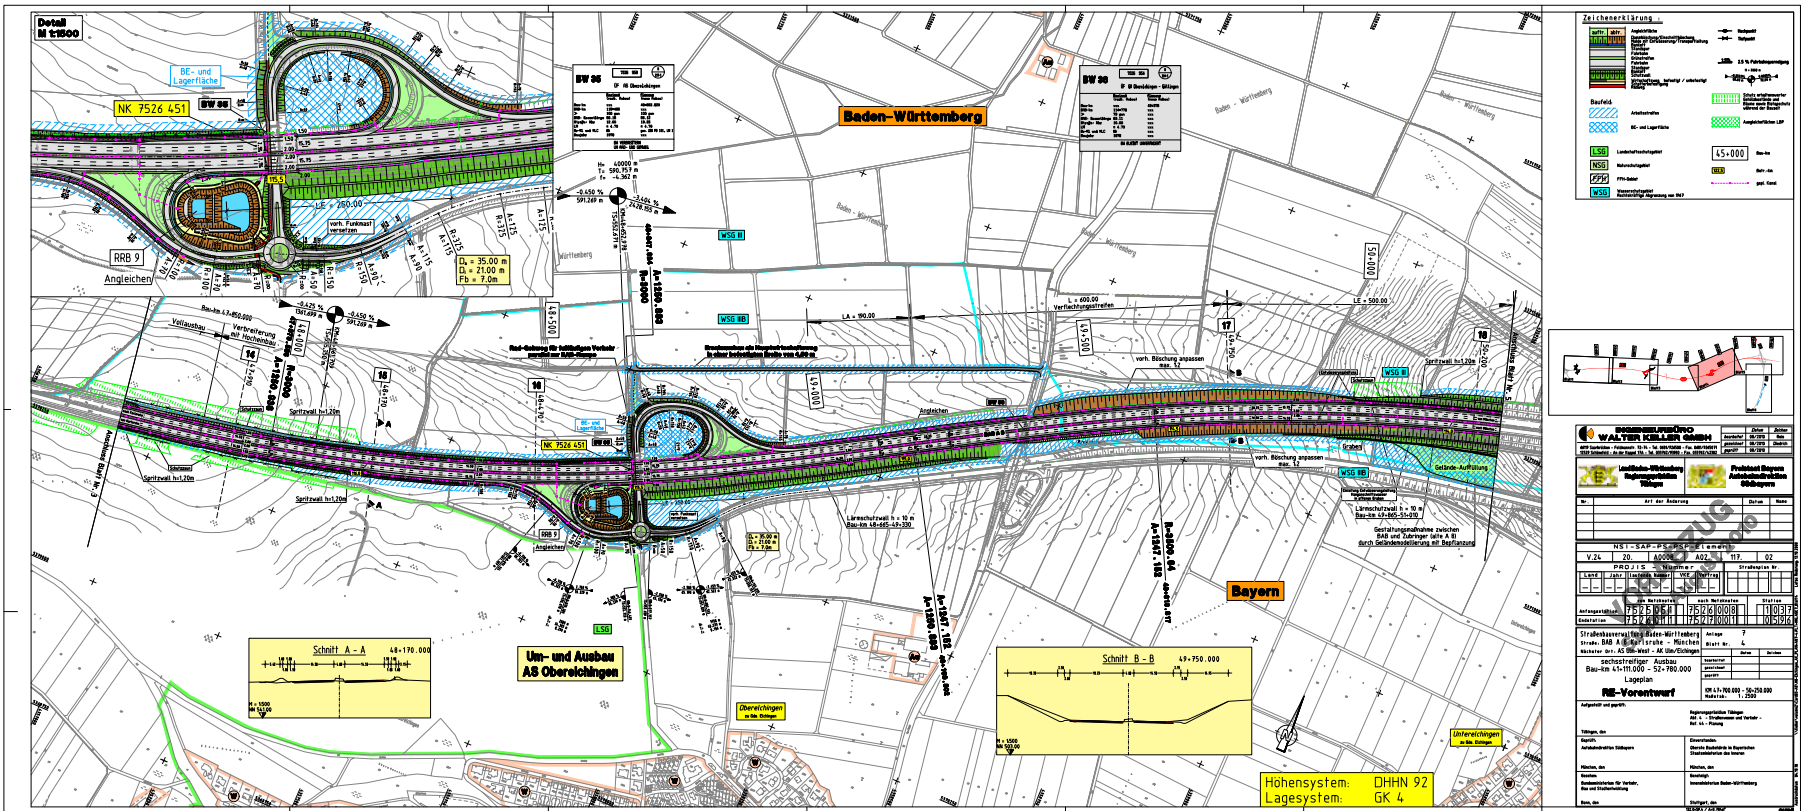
Lageplan - Ertüchtigung des bestehenden Anschlusses Oberelchingen 1
